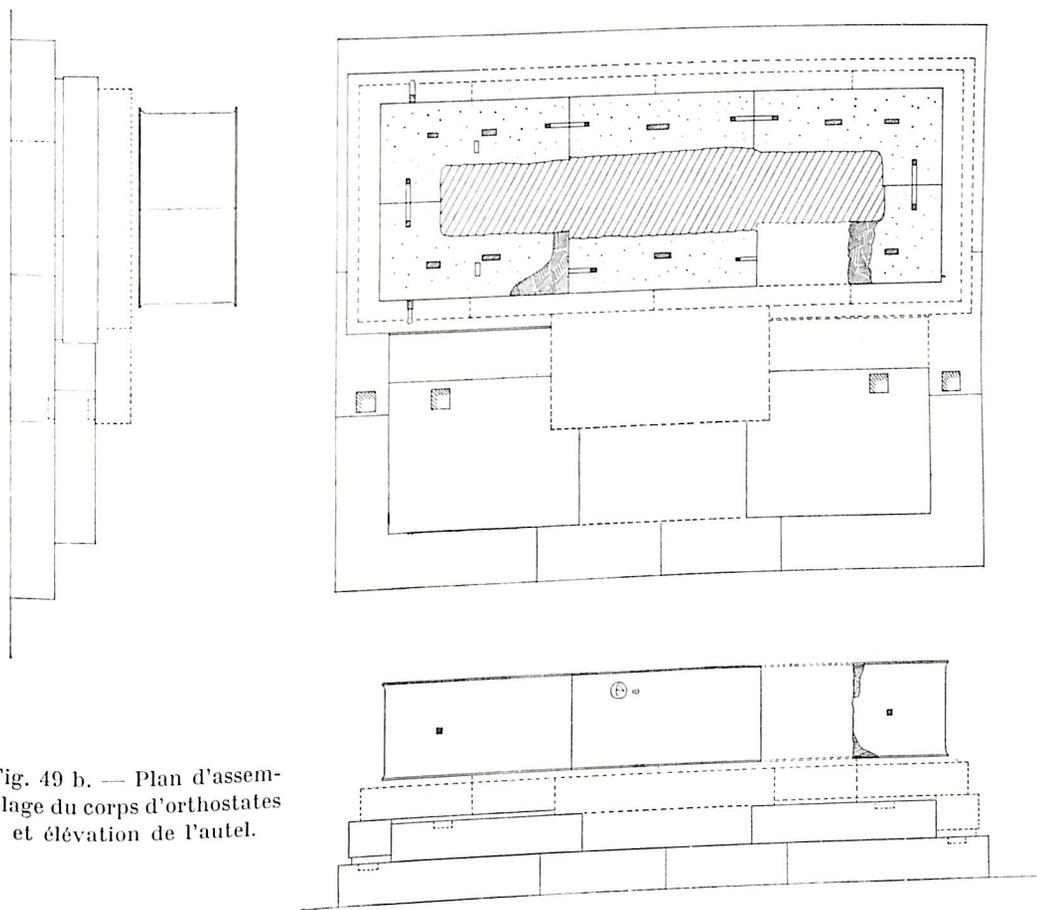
b. — Plan d'assemblage du corps d'orthostates et élévation de l'autel.
